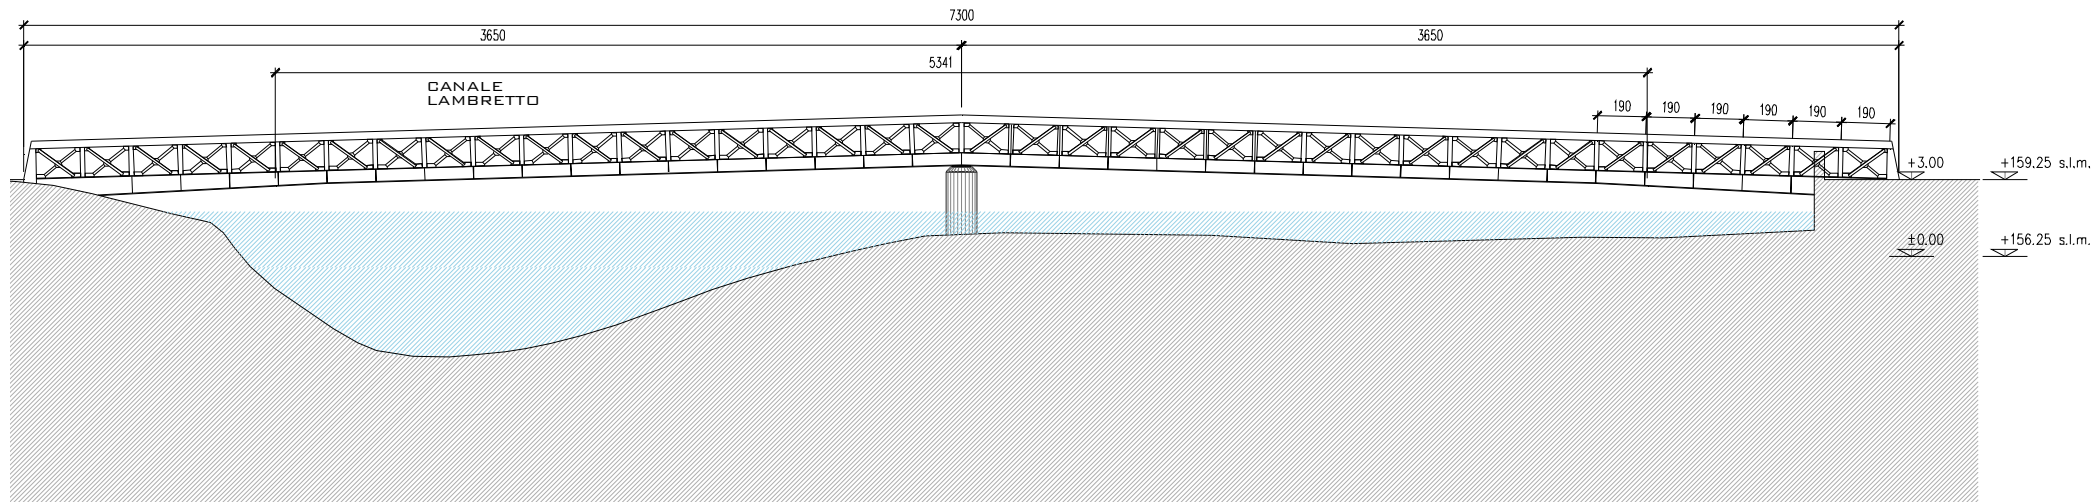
Prospetto del ponte in progetto, con dettaglio dell'impalcato
